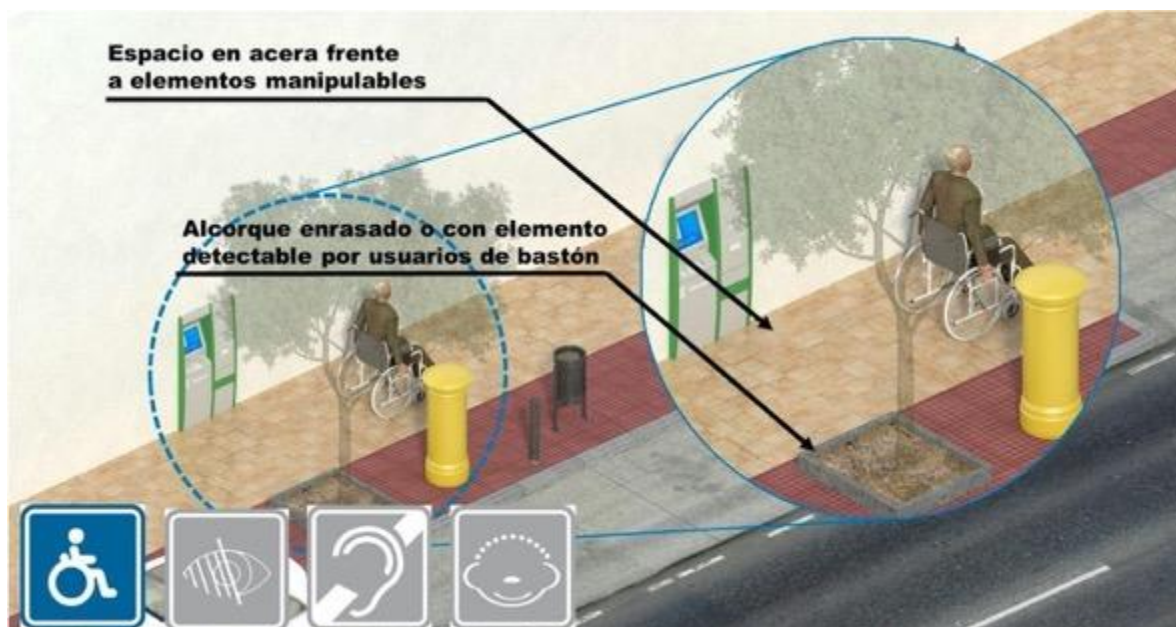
Detalles de diseño. Colocación de alcorques no enrasados con el pavimento
